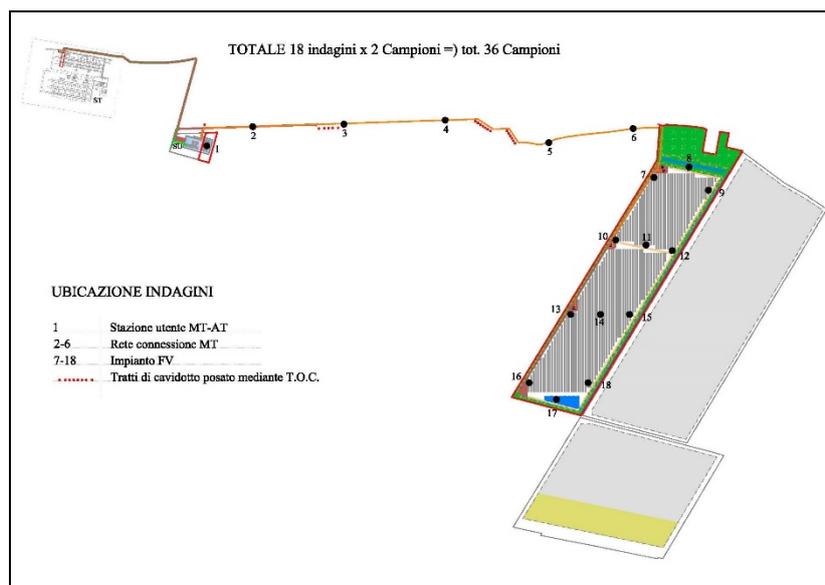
/67 – Planimetria con individuazione dei punti di prelievo
